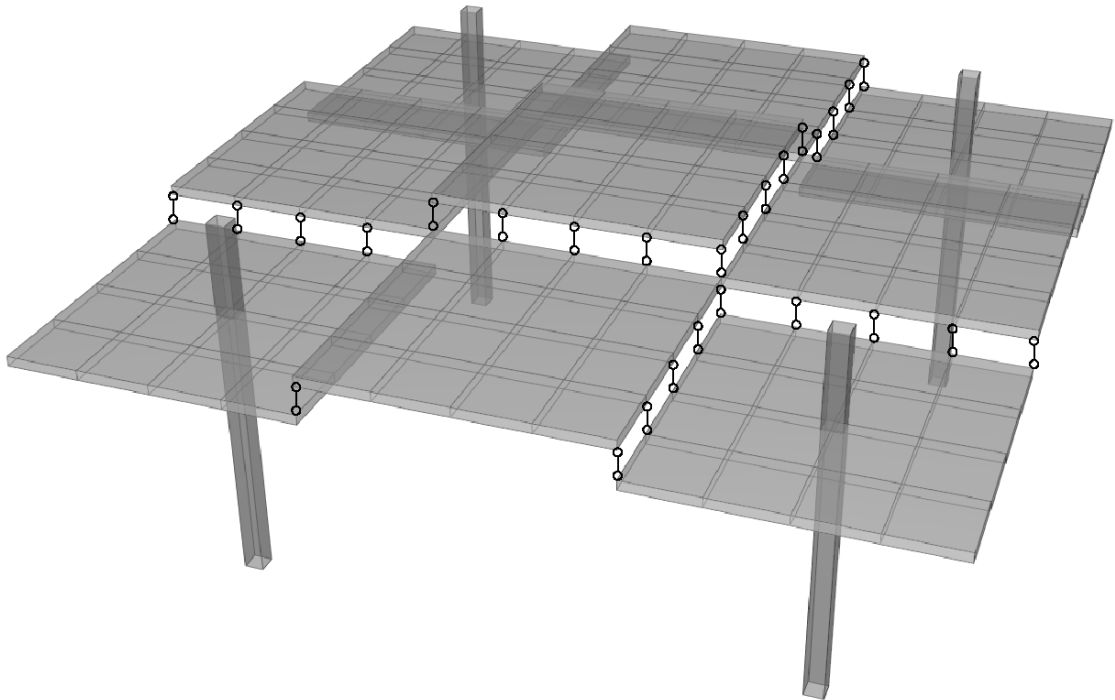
Розрахункова модель сталезалізобетонного безбалкового перекриття
